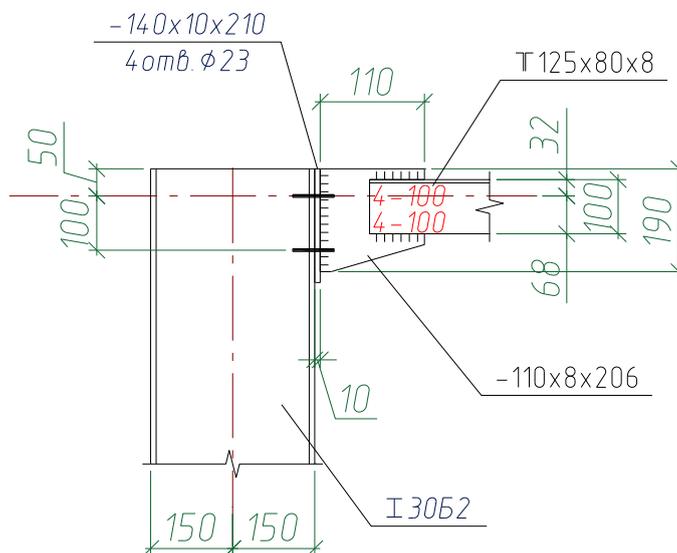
Узел примыкания верхнего пояса с надколонником
